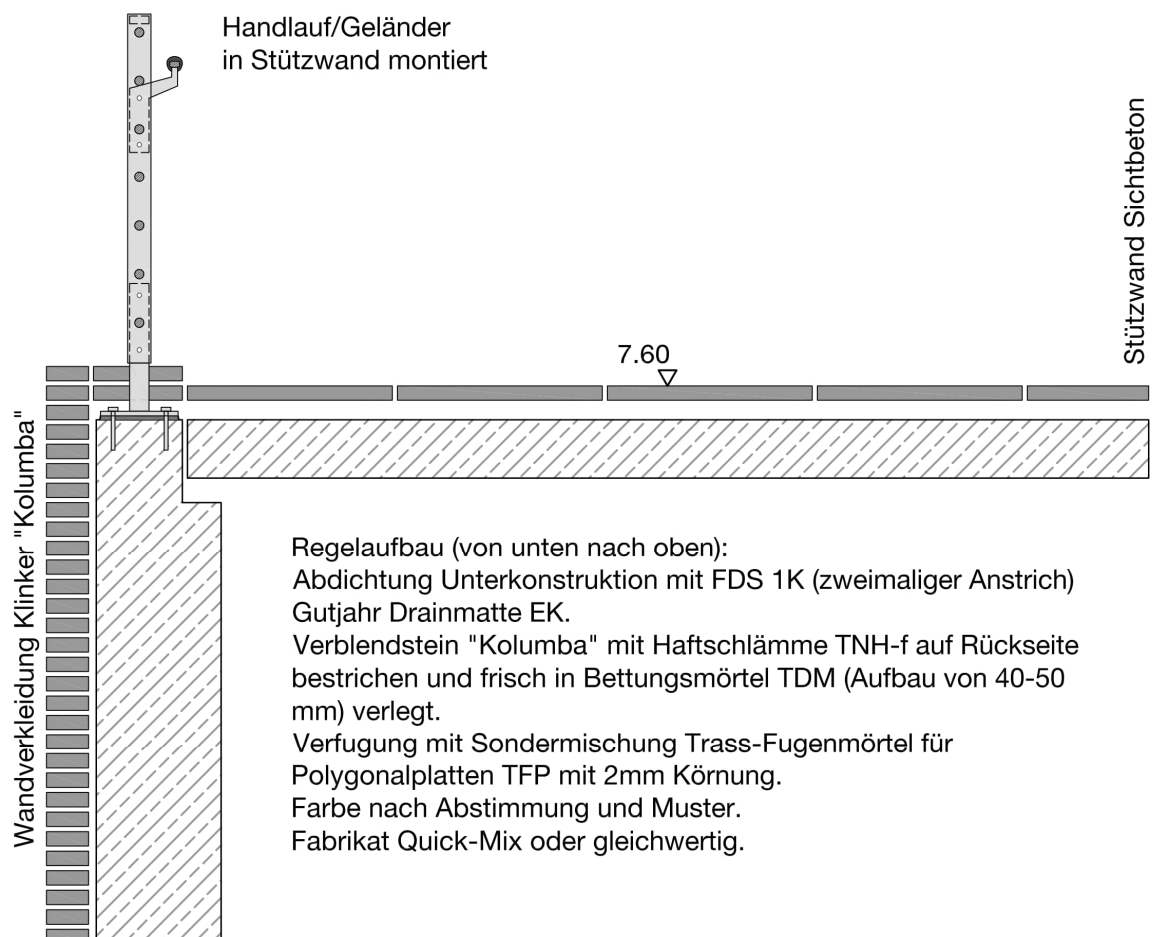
Auszug aus Ausführungsplan – Treppen- und Rampenanlage
